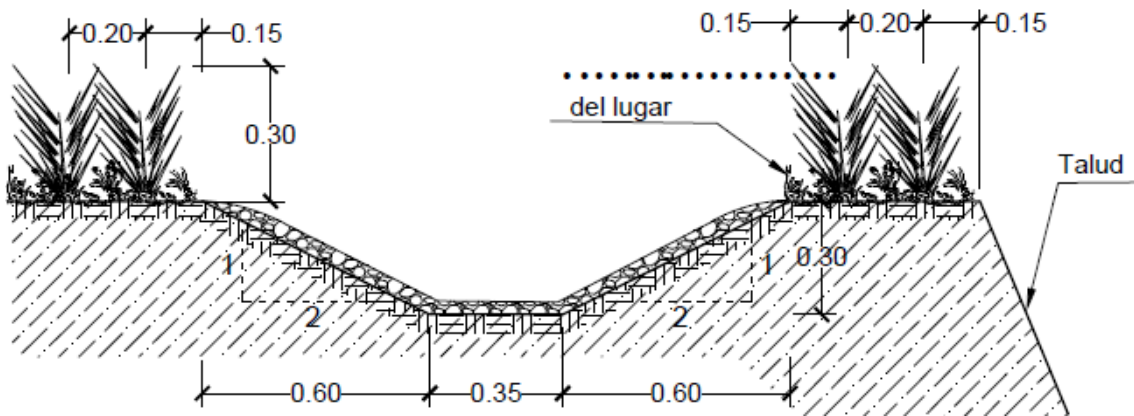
Detalle típico Perimetral C-2 (sin escala)
